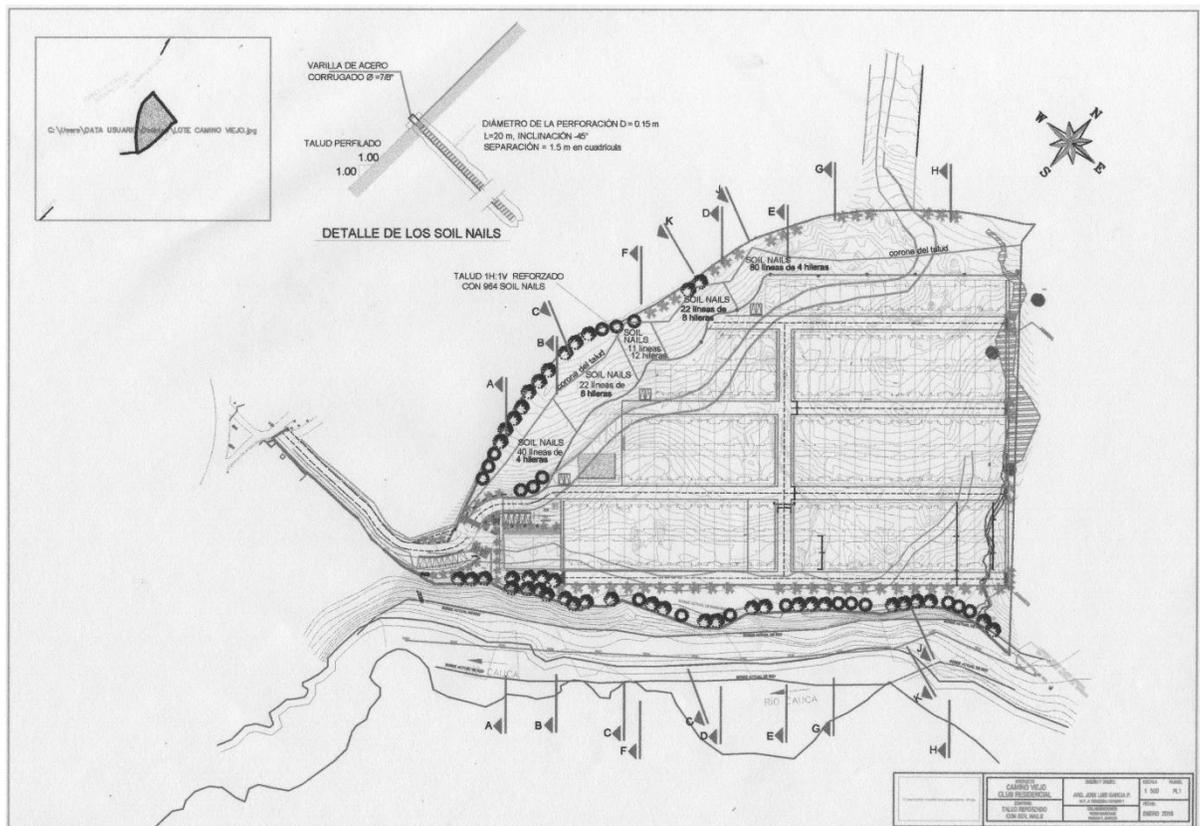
Plano ubicación de Soil Nails. Fuente estudio de suelos, Ing. Carlos E. Escobar.
